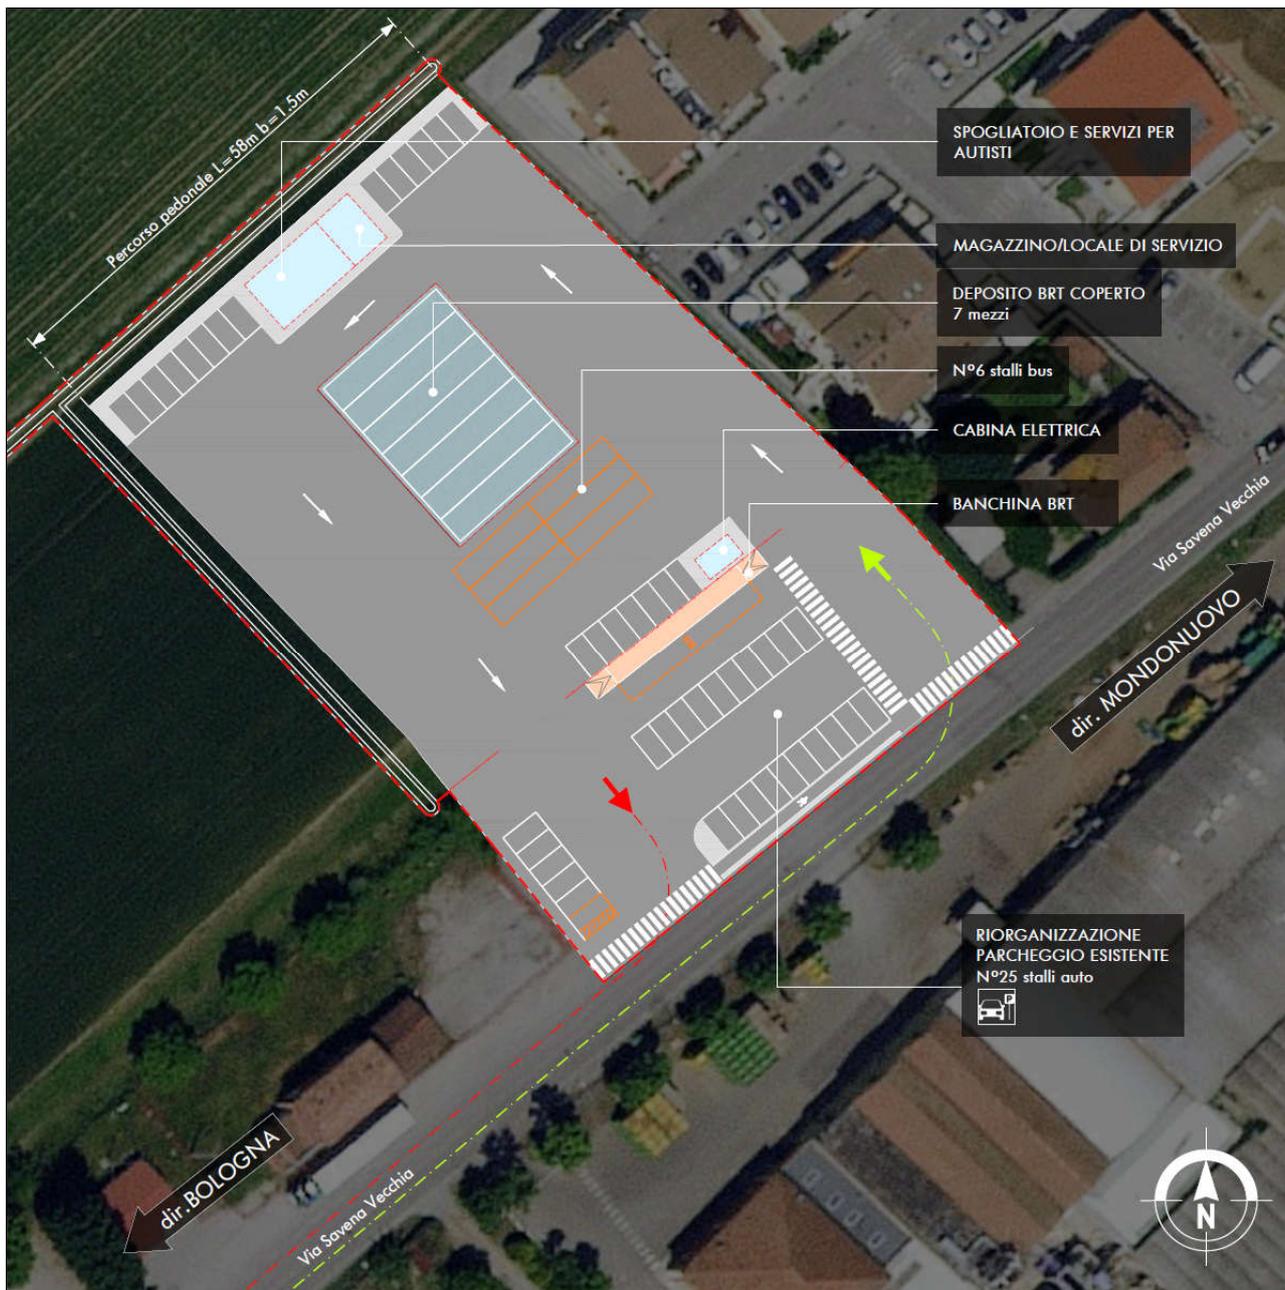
Capolinea e deposito di Baricella. Planimetria.
